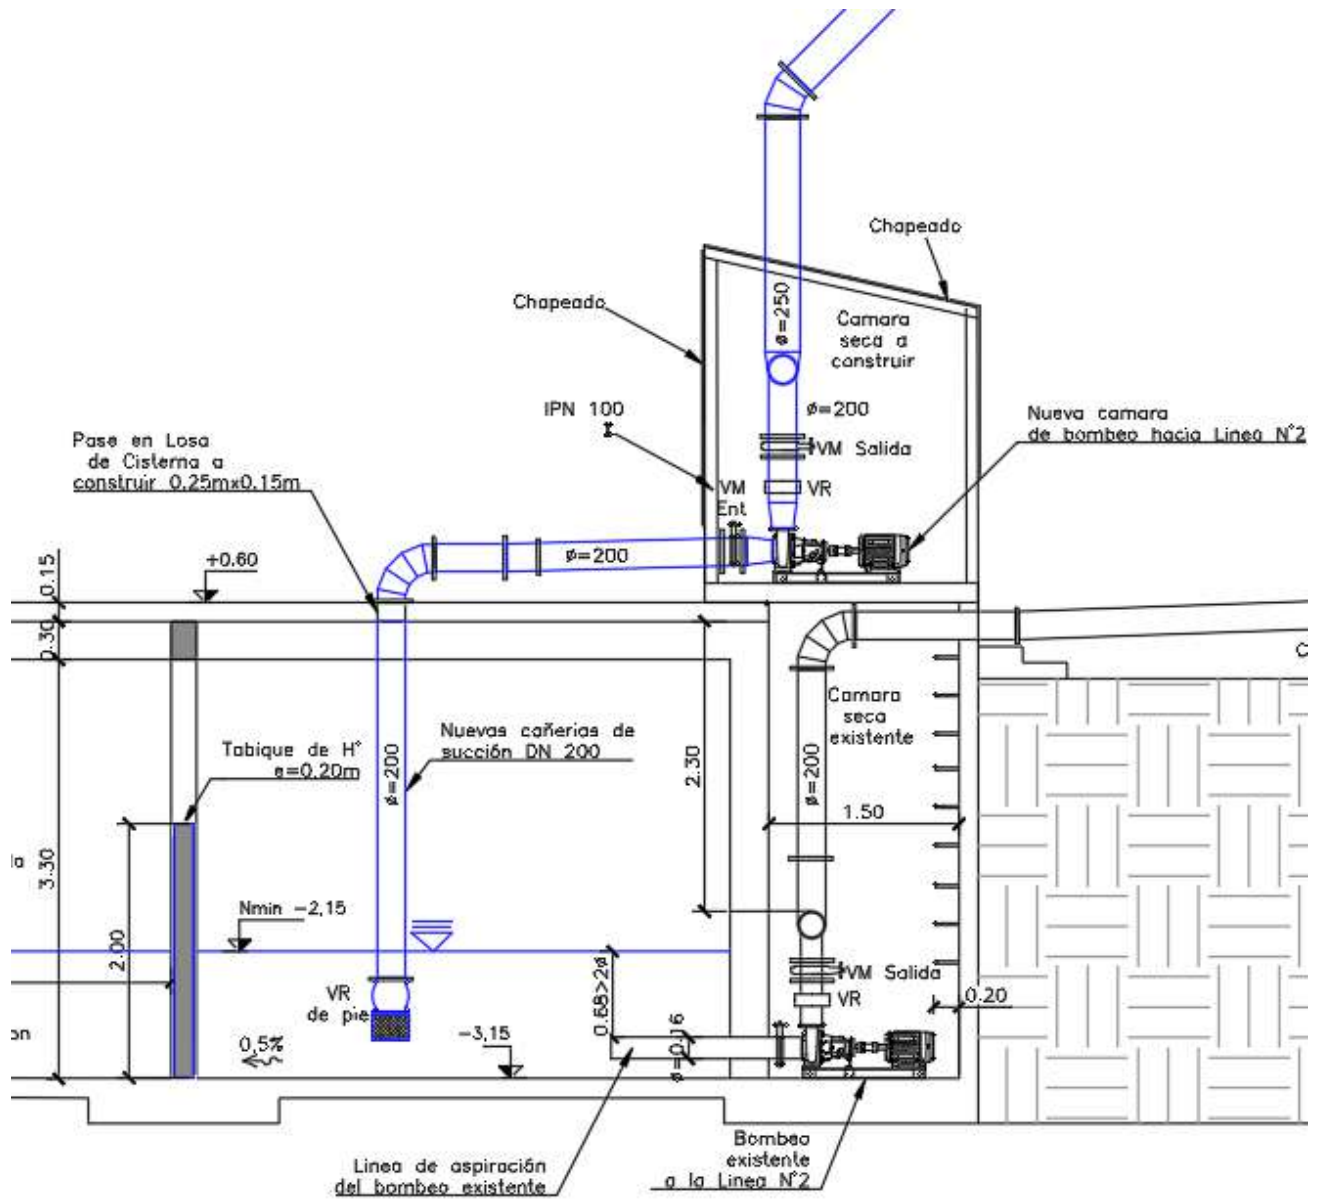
Diseño de nuevo sistema de bombeo en Corte – Fuente de elaboración propia
